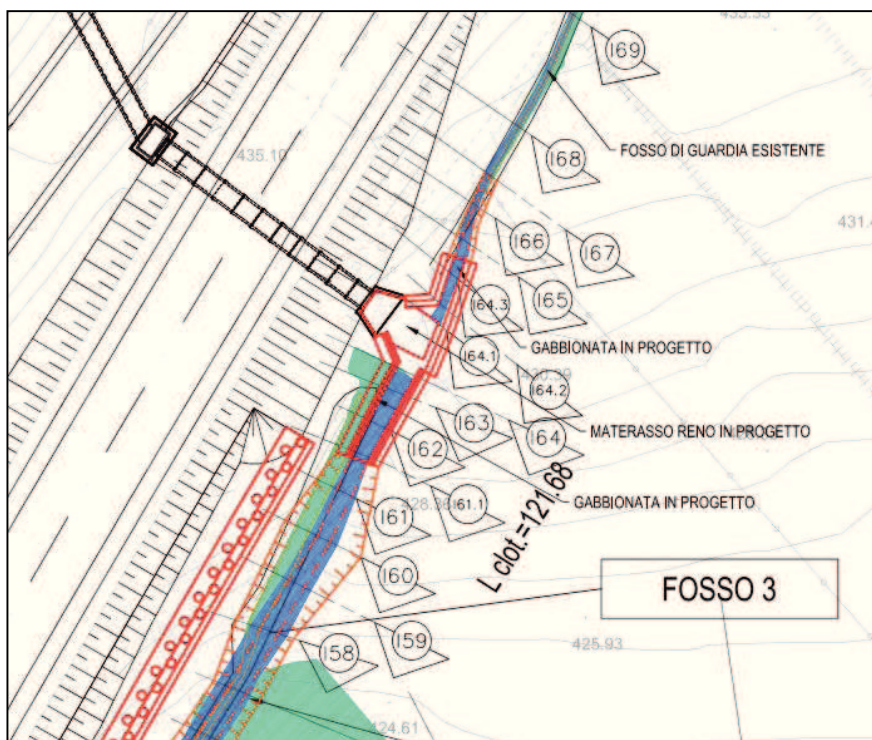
Stralcio planimetria aree esondabili in condizioni di stato di fatto e di progetto TR 100 anni – fosso 2 e fosso 3
